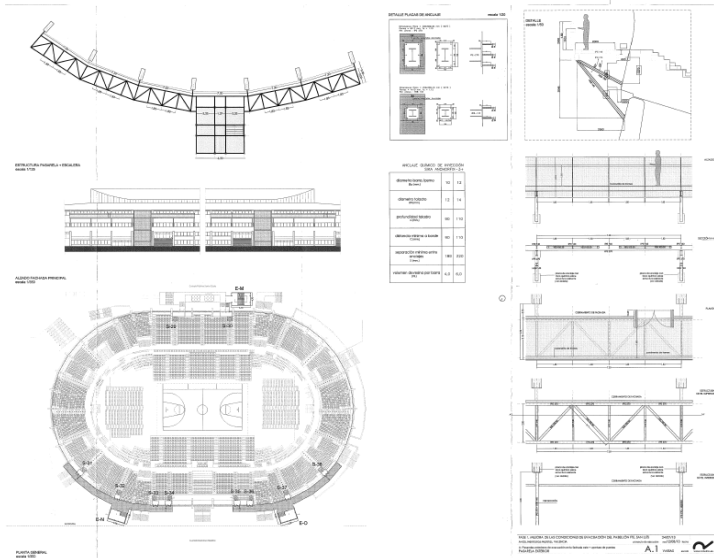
Plano de Pasarela Exterior. Plano 22.
